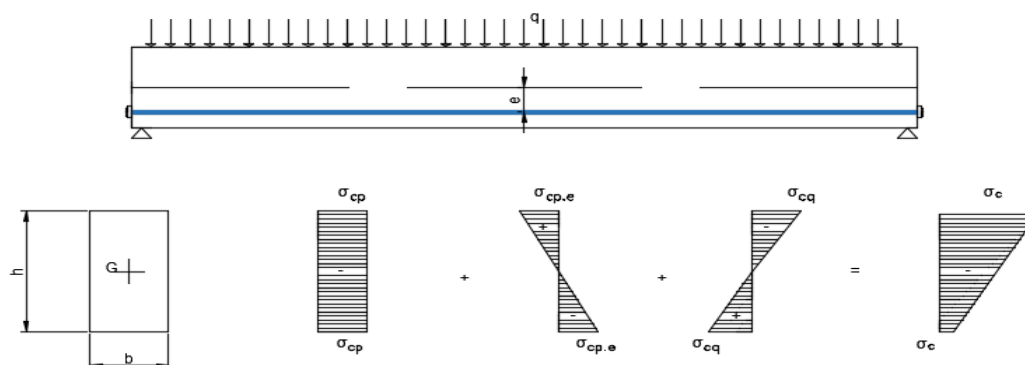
| 3 – Carregamento vertical de uma peça de betão armado pré-esforçado com pré-esforço excêntrico
